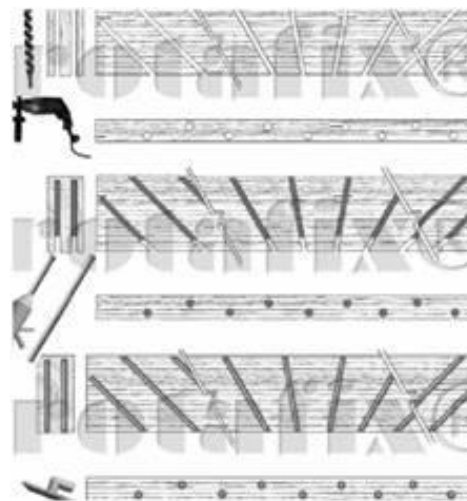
Introdução de elementos metálicos nas fendas [53]
